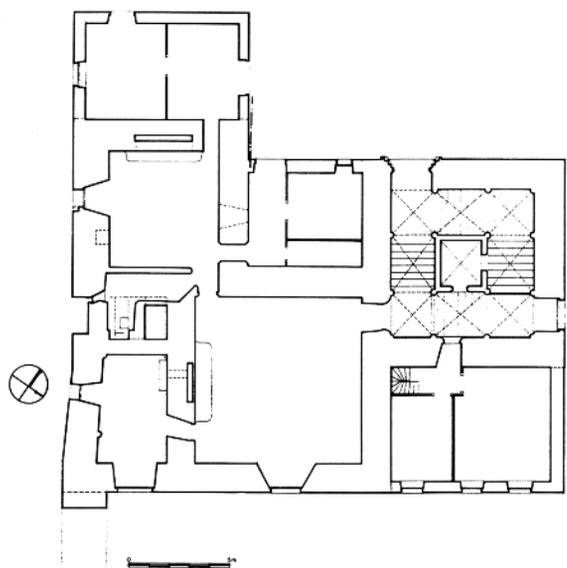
Larrazet, château, plan (dessin R. Martin, 1998).
